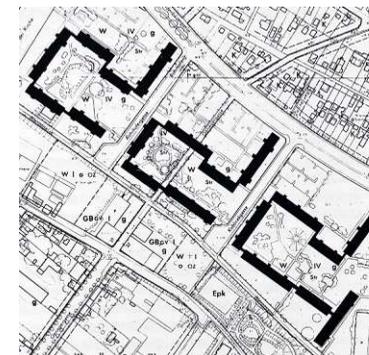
2. Generation: Lageplan Lindenbauergasse - Mitterweg
